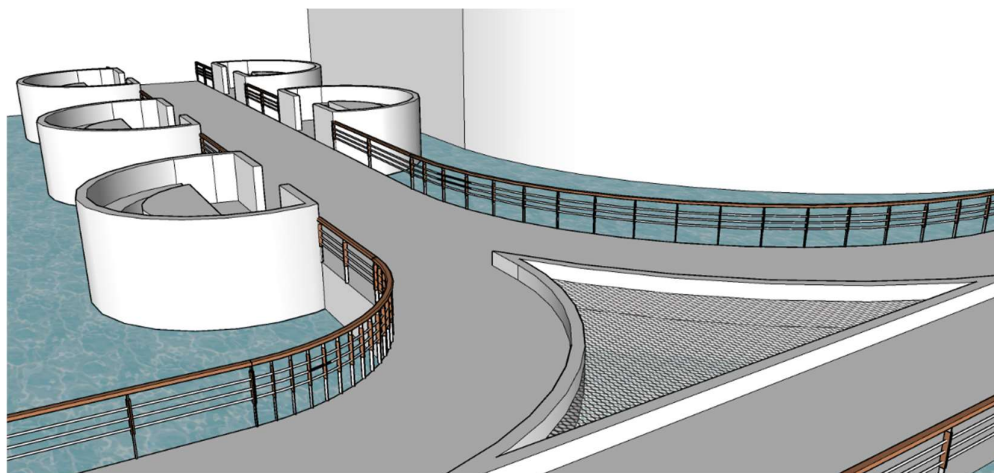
Konsep Ruang Dalam Ruang *Workshop
